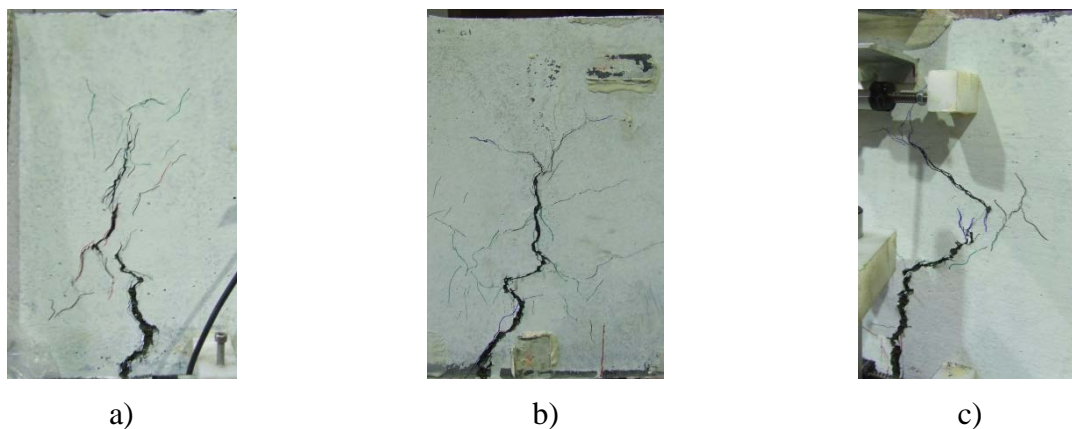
Profil de fissuration observé pour les poutres a) 75 mm b) 125 mm c) 150 mm
